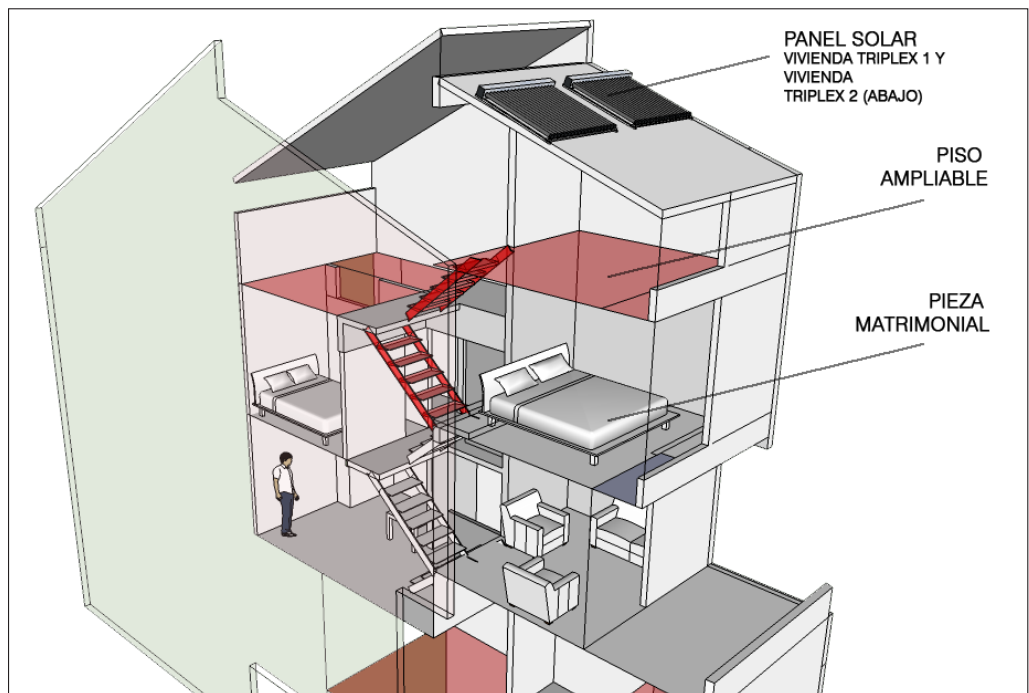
Detalle modelo 3D de sección para vista interior de departamento. En rojo las zonas ampliables.
